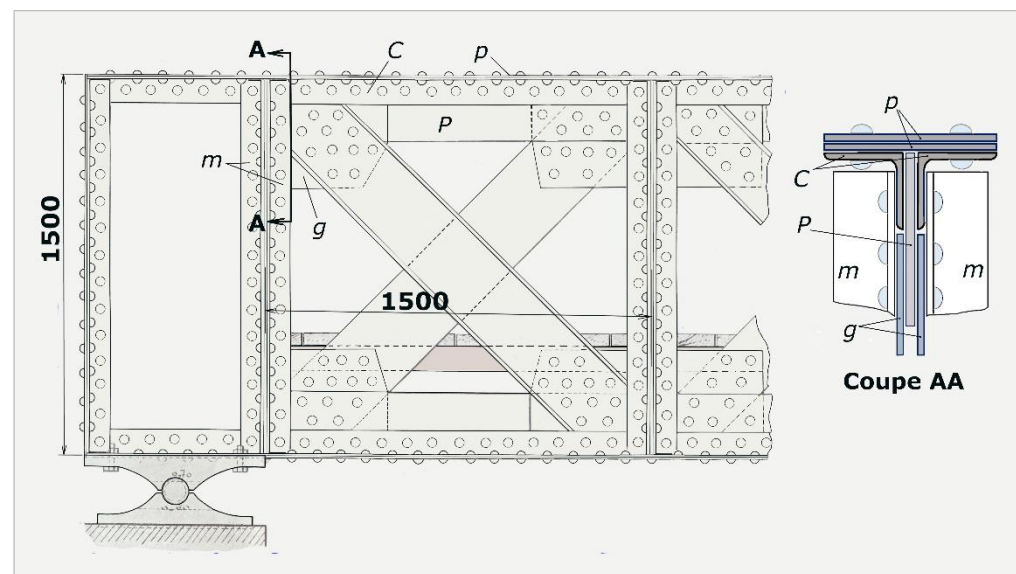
Détail de la vue en élévation de l'appui sur la culée et coupe d'une membrure
